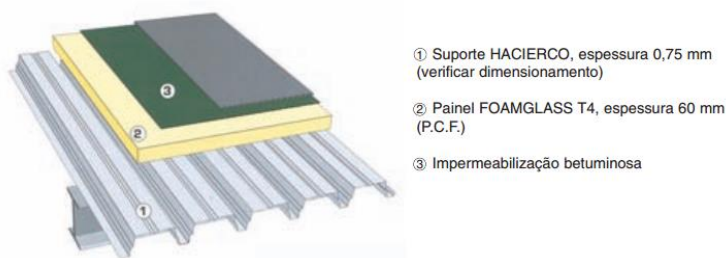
Sistema construtivo da cobertura com impermeabilização betuminosa (adaptado de Haironville Portugal)
